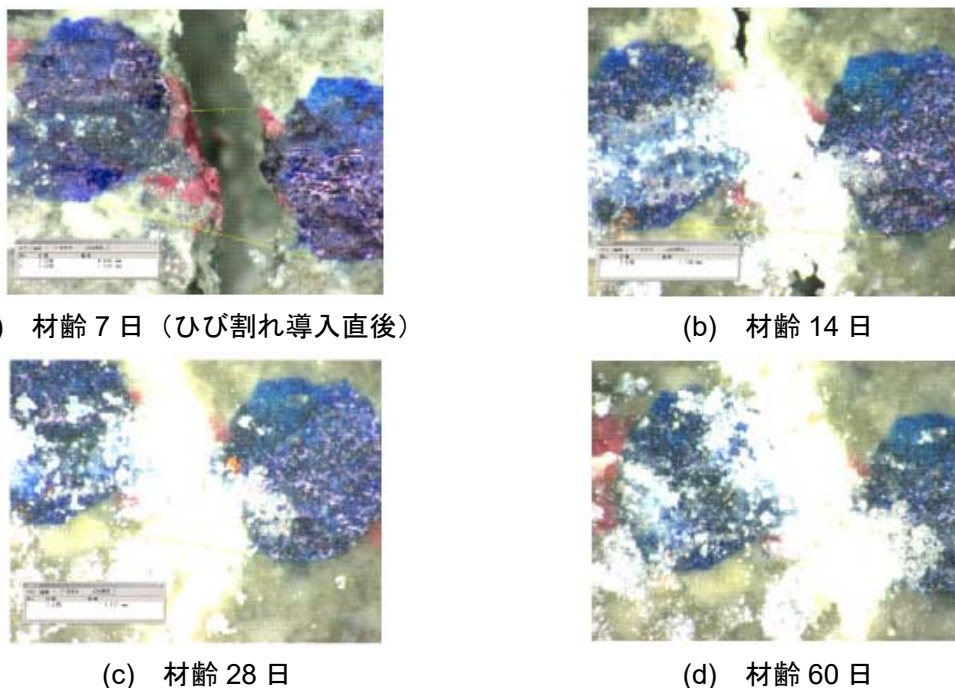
コンクリートのひび割れ閉塞状況[2.25]
